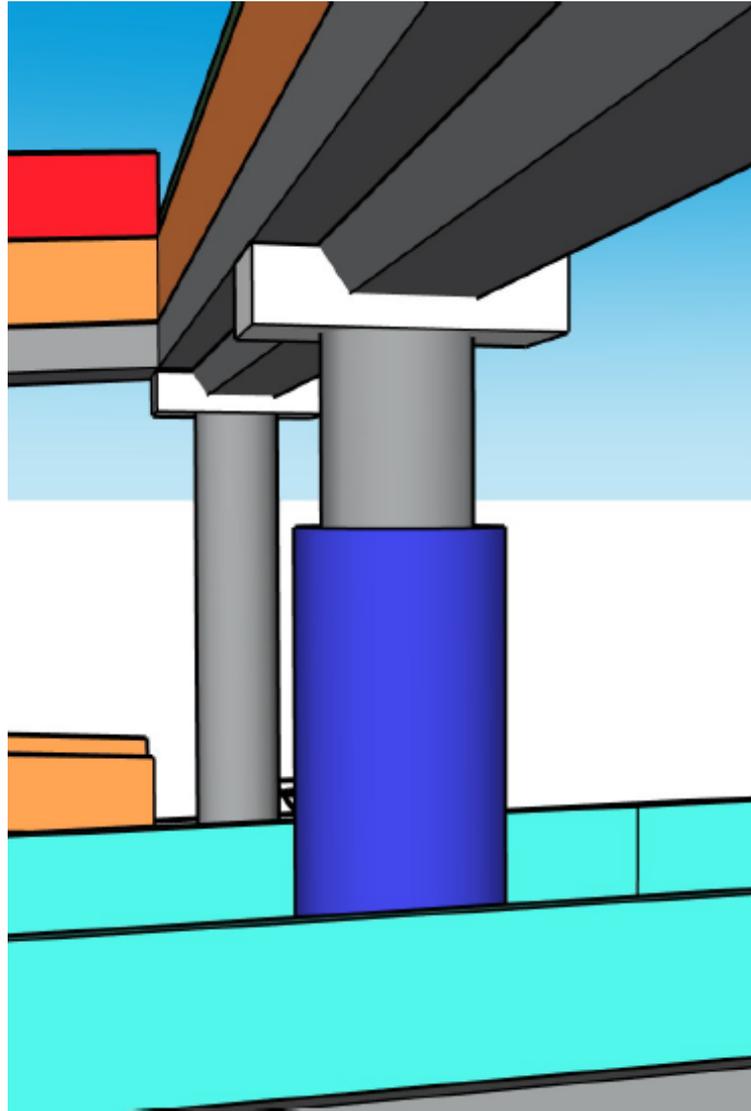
Pilar con cabezal de apoyo y topes laterales.
